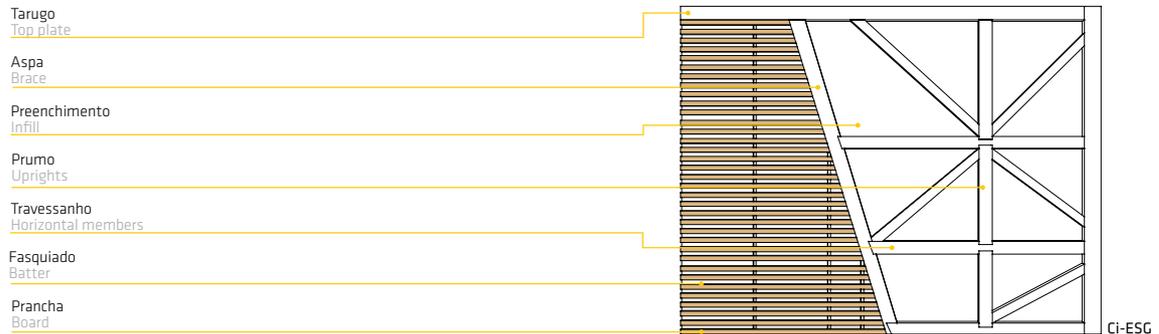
Estrutura interna das janelas de traapeiras Internal structure of a roof window
